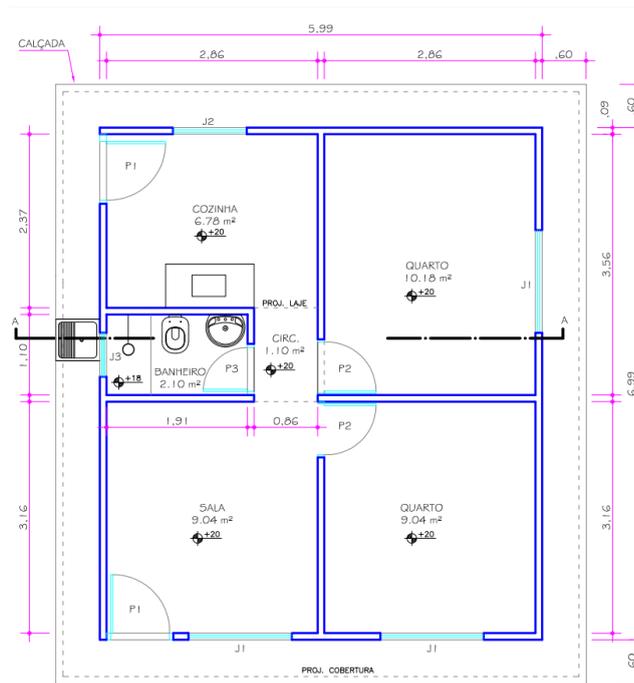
Planta Baixa. Fonte: Cadernos CAIXA Projeto padrão – casas populares | 42m²
